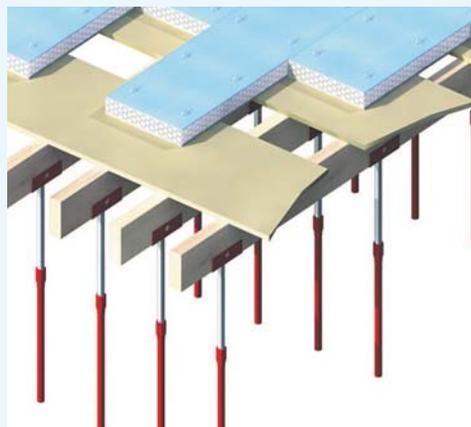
Mise en place des panneaux en coffrage isolant traditionnel
